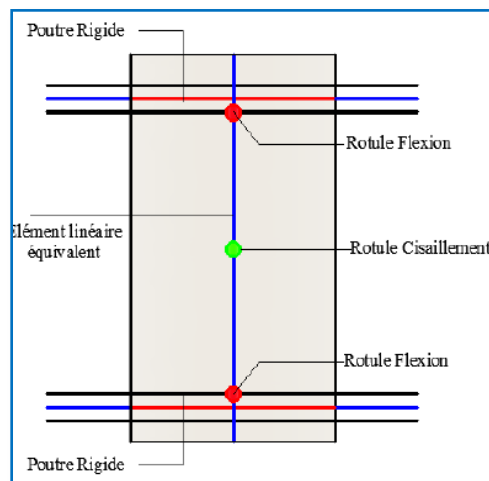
Modélisation du voile par un élément poteau-poutre équivalent.
